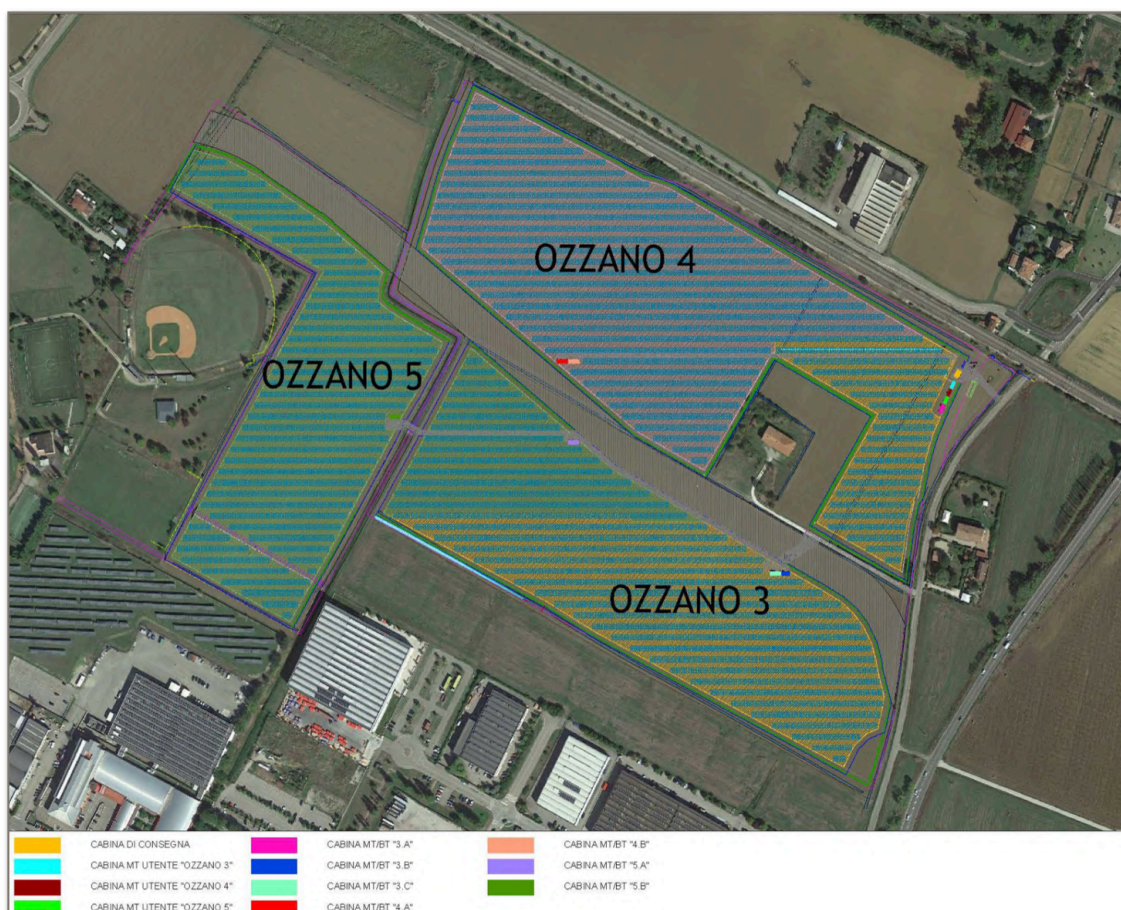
Vista aerea Sito di Produzione/Utilizzo nello stato finale
